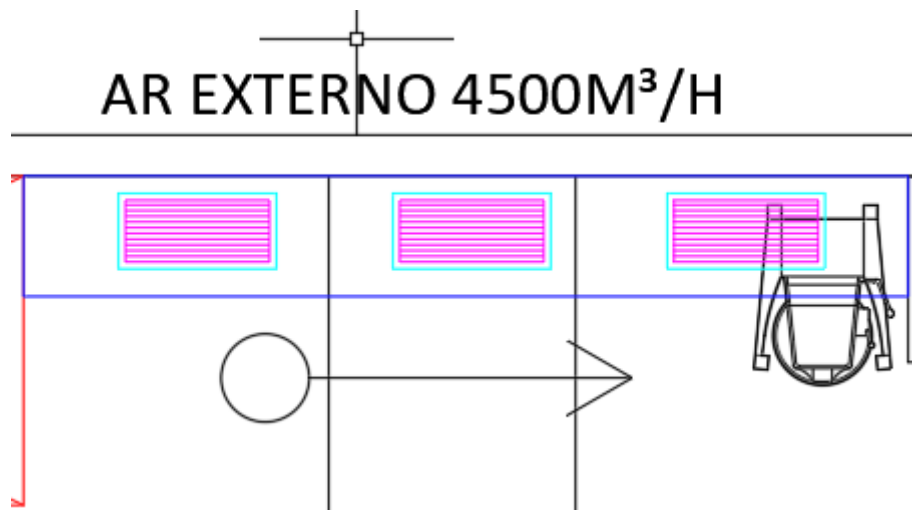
Insuflamento de ar para técnica de cortina de ar
